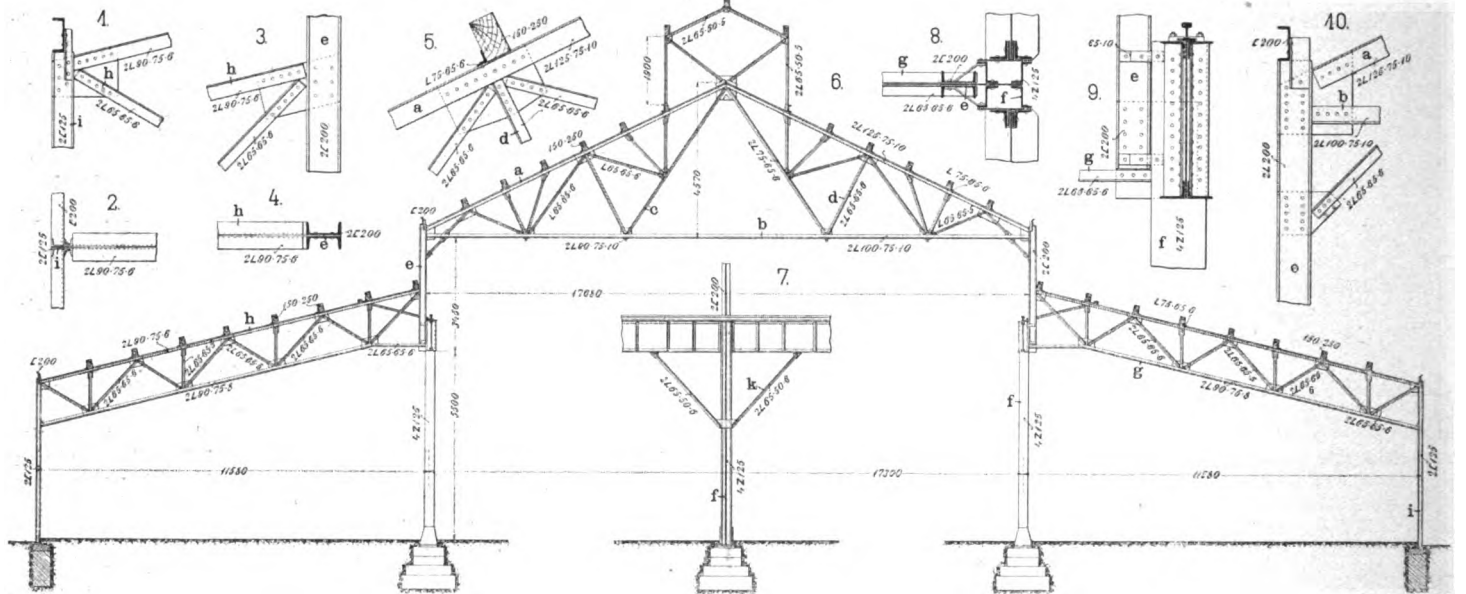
Eiserne Dachkonstruktion des Walzwerkgebäudes der American Rolling Mill Company in Middleton.
